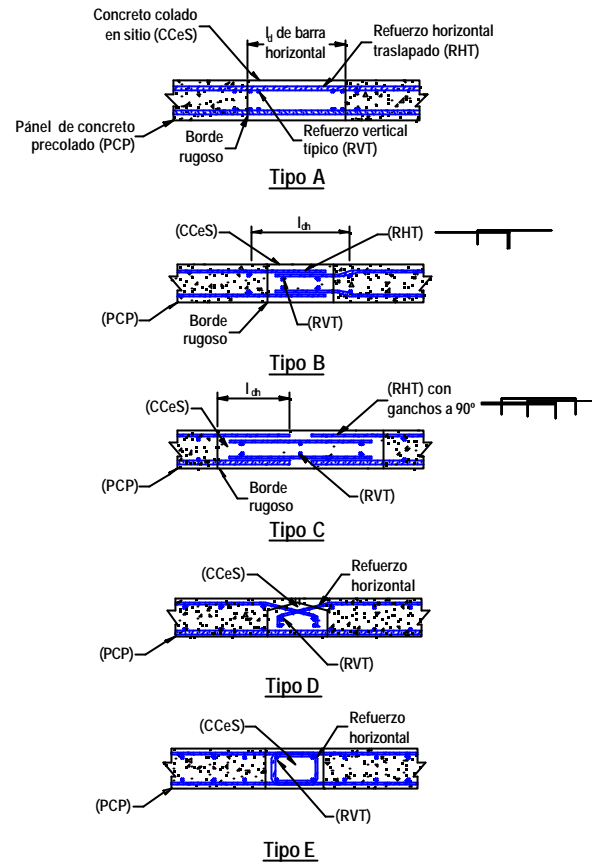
Detalles de conexiones verticales entre muros de concreto prefabricado (Park, 1995)
